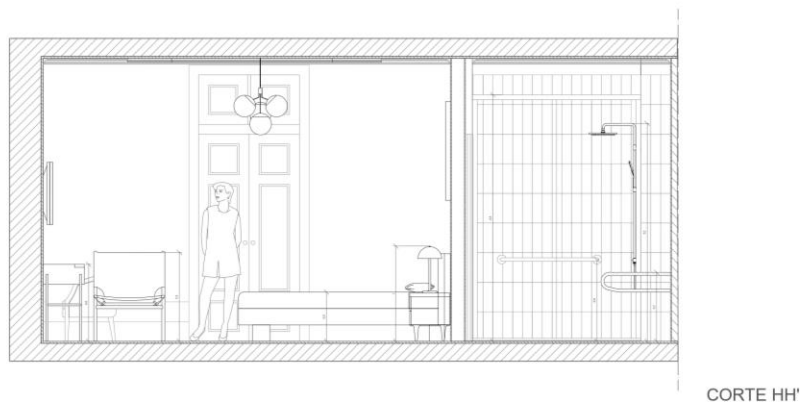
Pormenorização. Corte HH'. Fonte: Ana Ferreira
